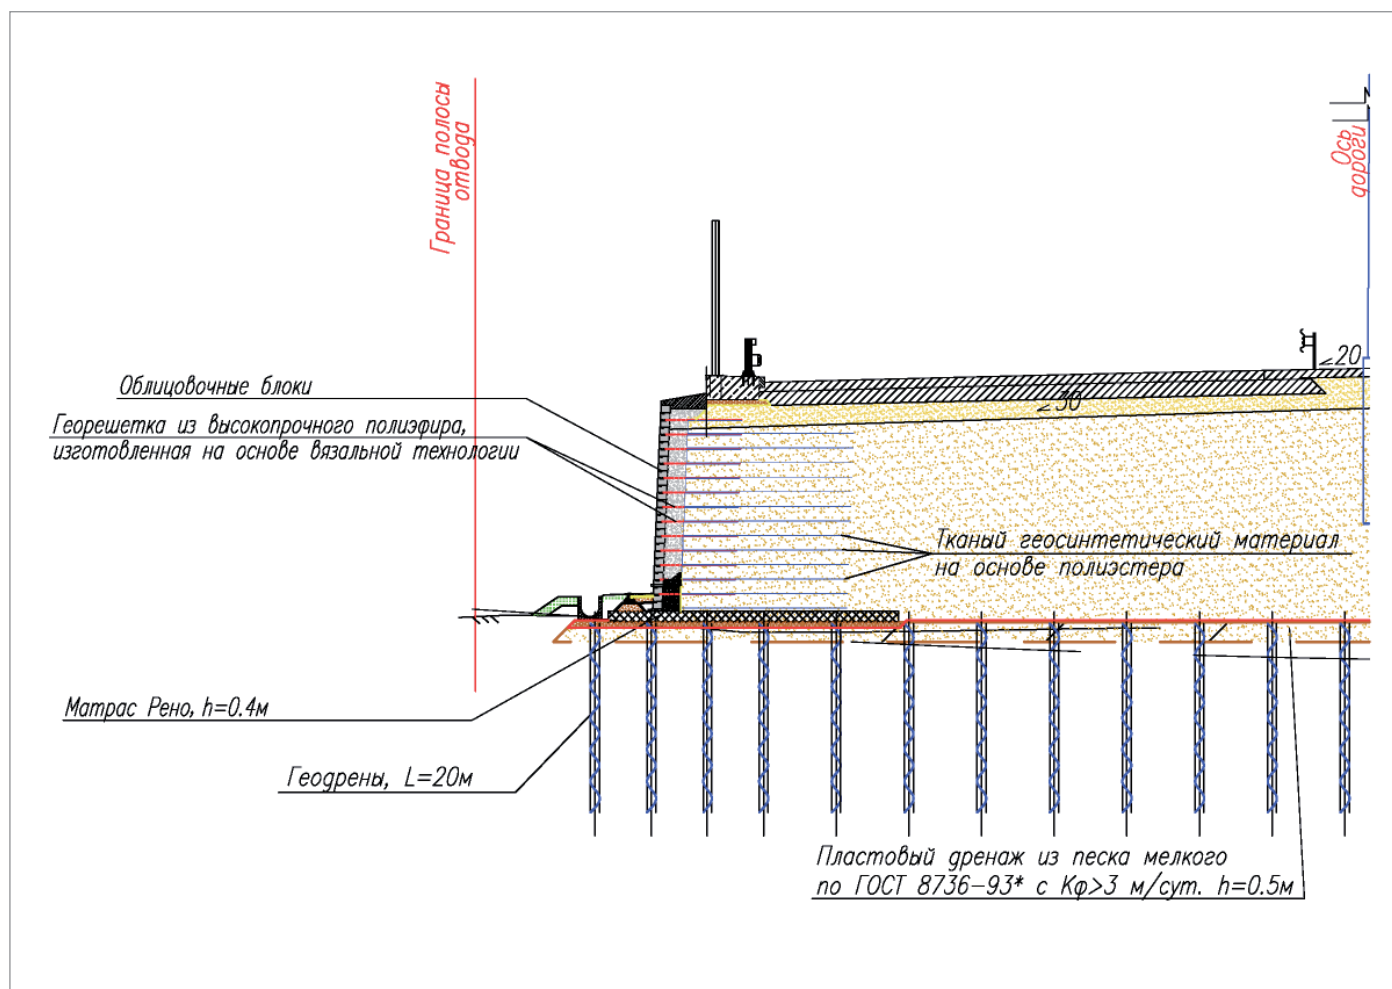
Конструкция армогрунтовой подпорной стены на слабом основании
